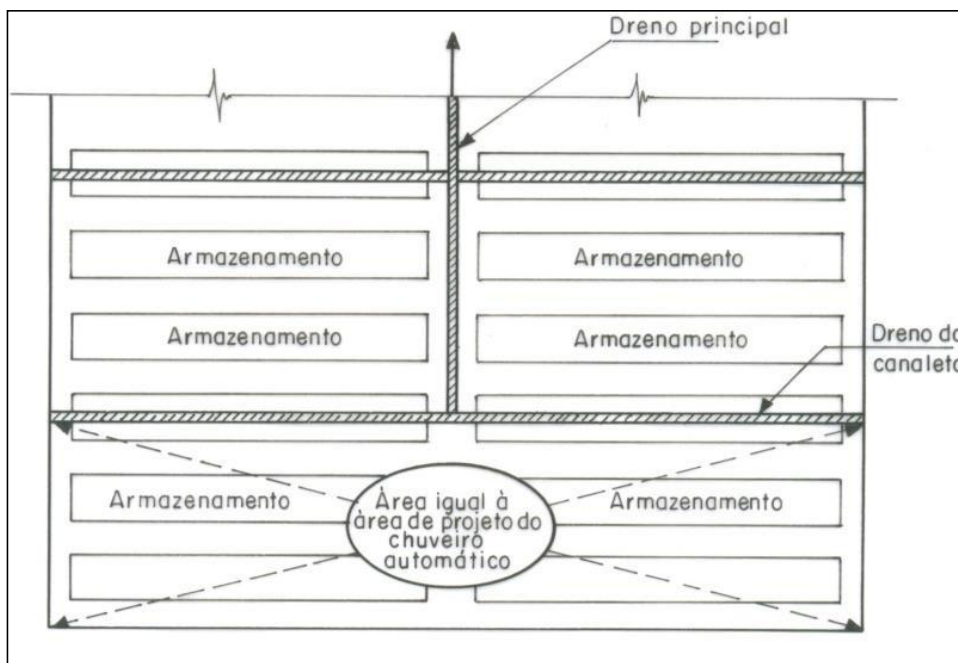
Vista em planta de controle de líquidos em armazéns.
